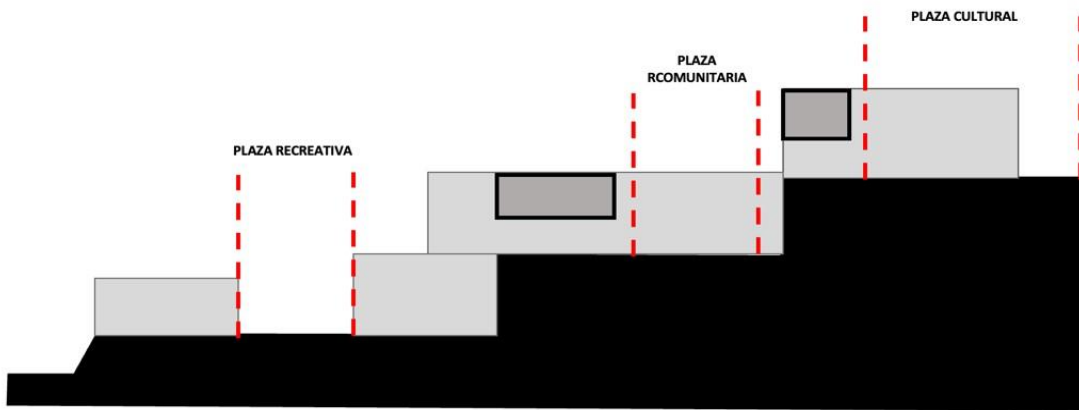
Esquema en corte de propuesta arquitectónica - Elaboración propia
